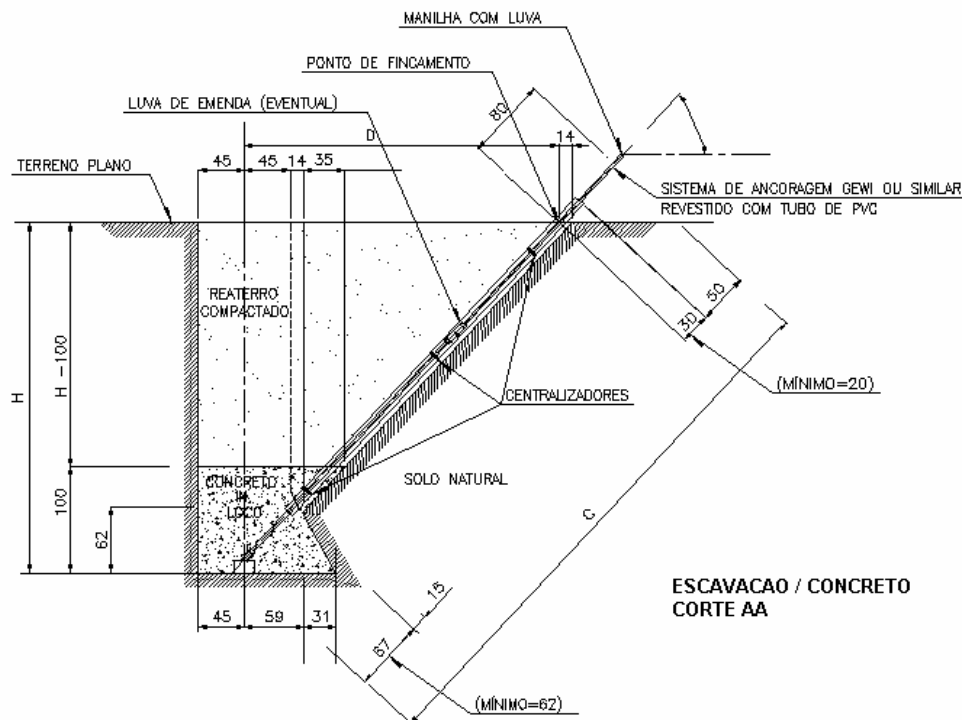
Fundação em tubulão para estais de torre estaiada de suspensão na LT Garabi-Itá.
